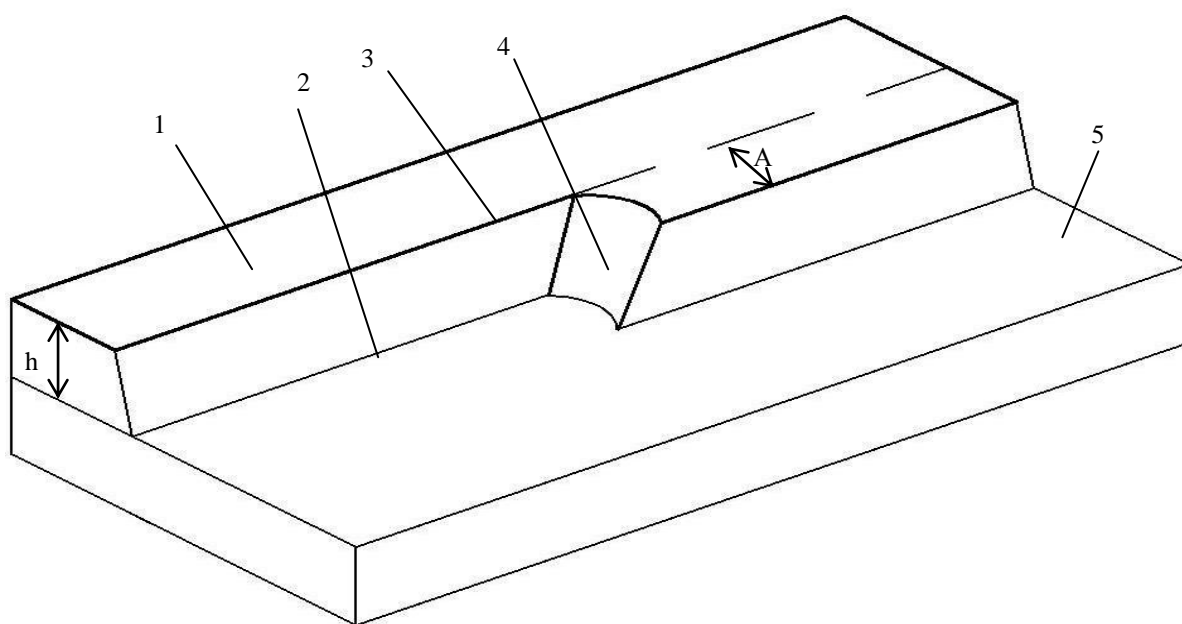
Схема уступа: 1 – верхняя площадка уступа; 2 – нижняя бровка уступа; 3 – верхняя бровка уступа; 4 – торец; 5 – нижняя площадка уступа; α – угол откоса уступа; h – высота уступа; A – ширина заходки.
